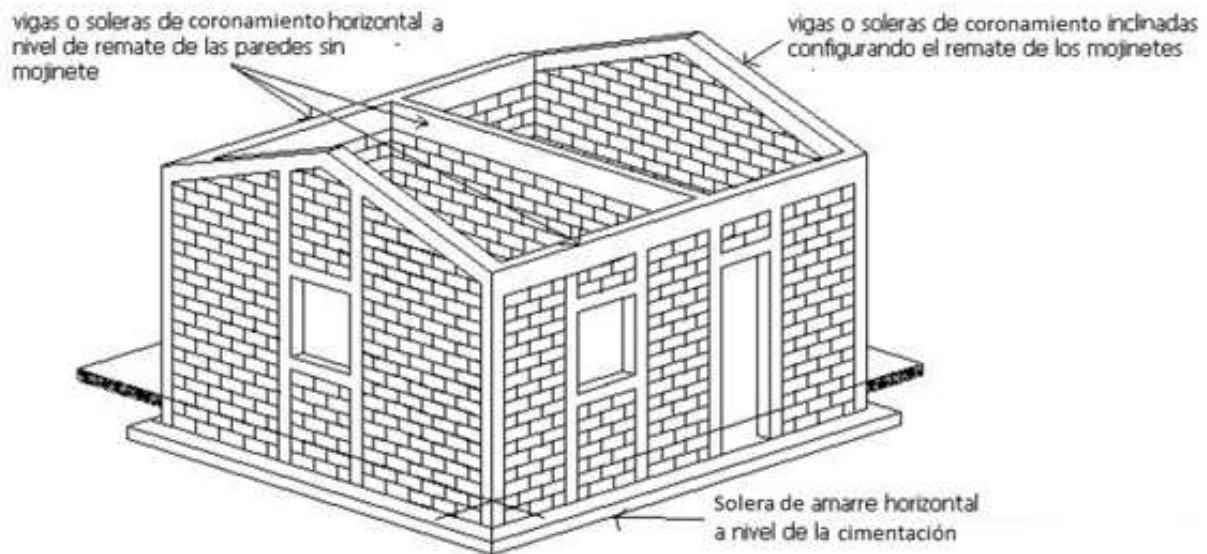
Vigas o soleras de amarre en viviendas de una planta- Opción 2
